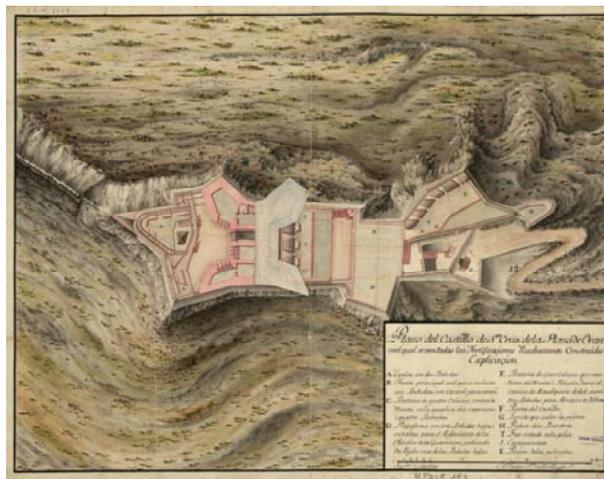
Propuesta del ingeniero Juan Ballester y Zafra de 1736 (AGS. Ref. MPD.05.153.p.4).
